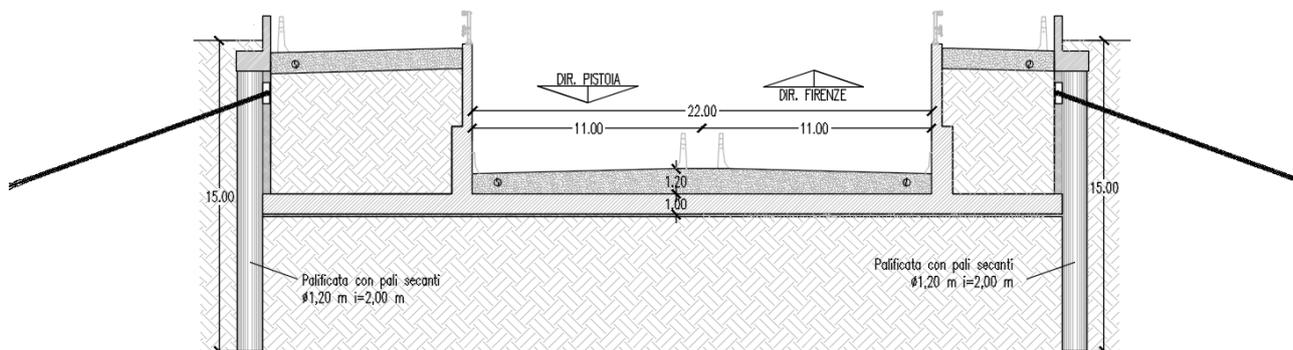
Sezione tipica con paratia tirantata nella zona con rampe lato via Nenni
